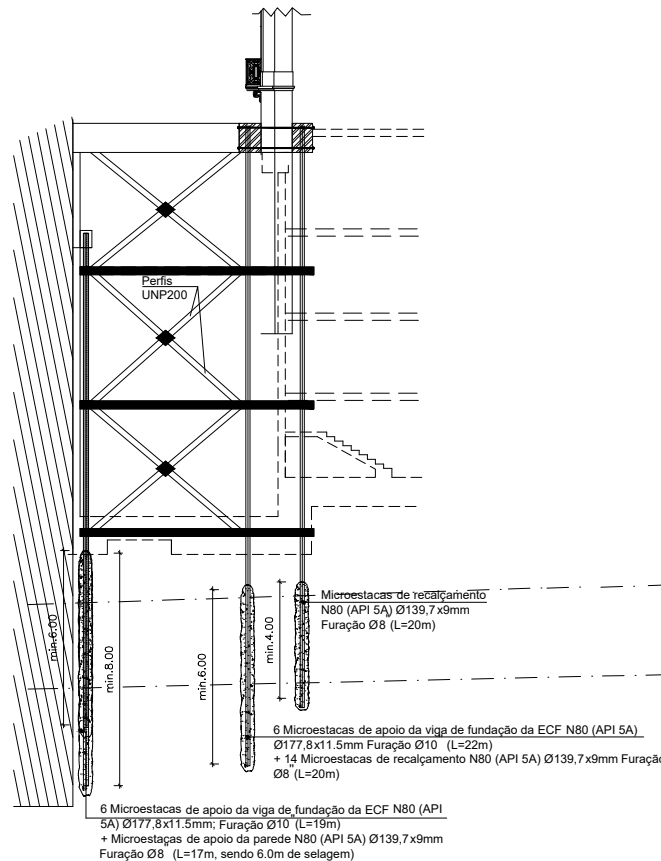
Corte tipo: Recalçamento das fachadas localizadas no tardo. Adaptado de [14]
